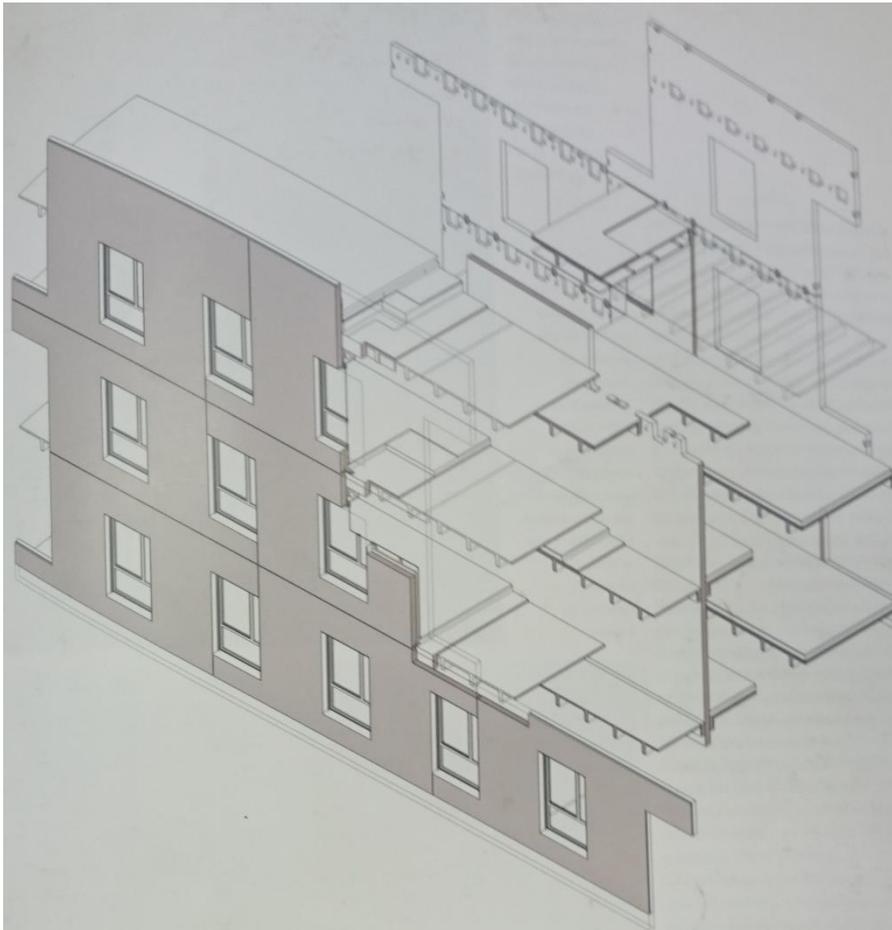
Piezas de cerramiento, entrepiso y estructurales.
